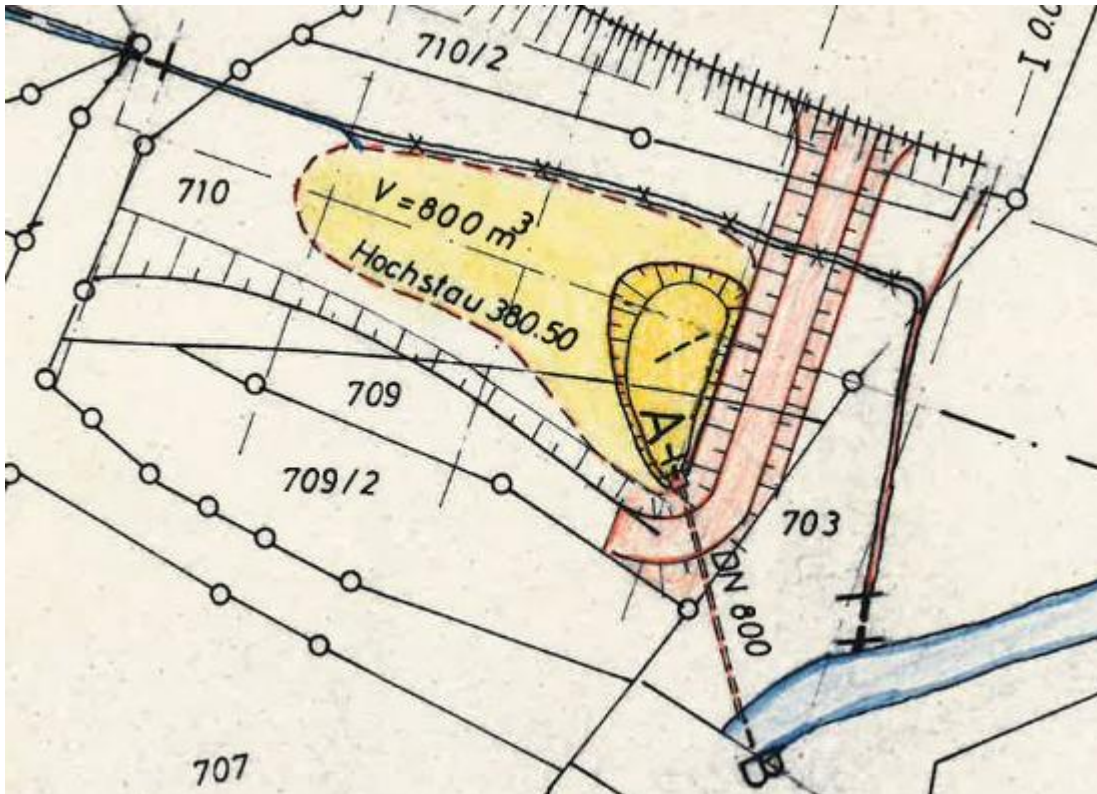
Auszug Lageplan WR Bescheid 1988
